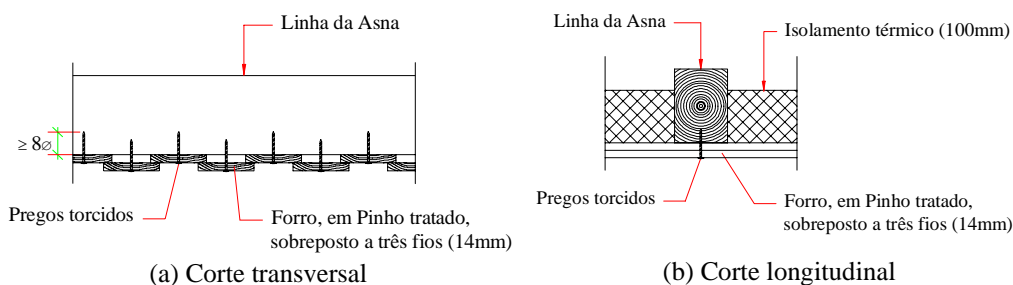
Corte transversal (a) e longitudinal (b) do tecto
